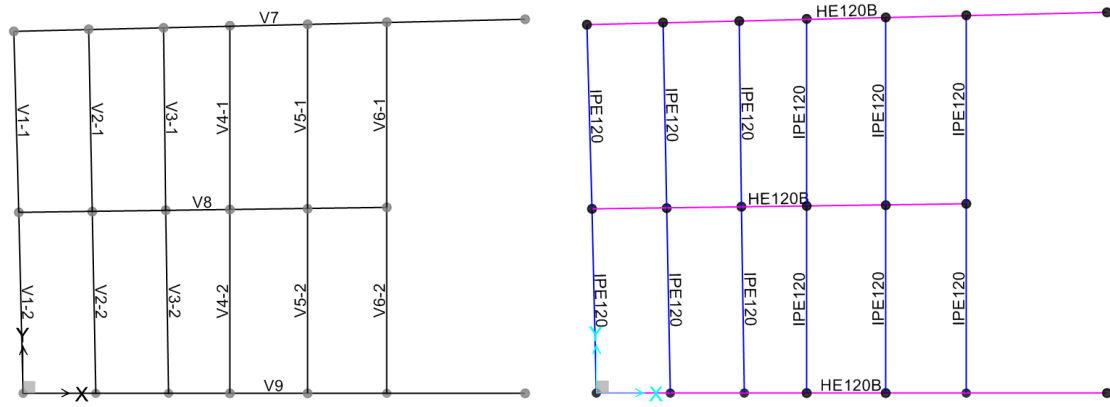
Numeração e secções das vigas metálicas da cobertura (V1 a V9)
